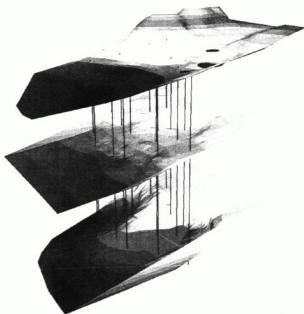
Тримірне зображення поверхонь рельєфу, ґрунтових вод і водотриву в умовах суцільних полів паль під фундаментами будівель
